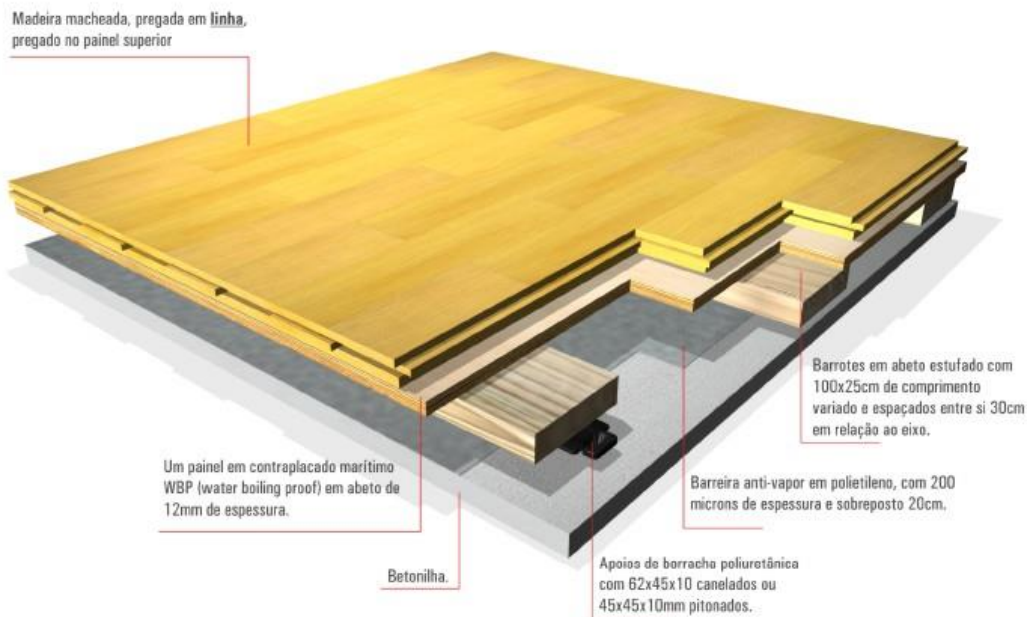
Figura G – Pavimento Desportivo em madeira flutuante e flexível com apoio em barrotamento reforçado
